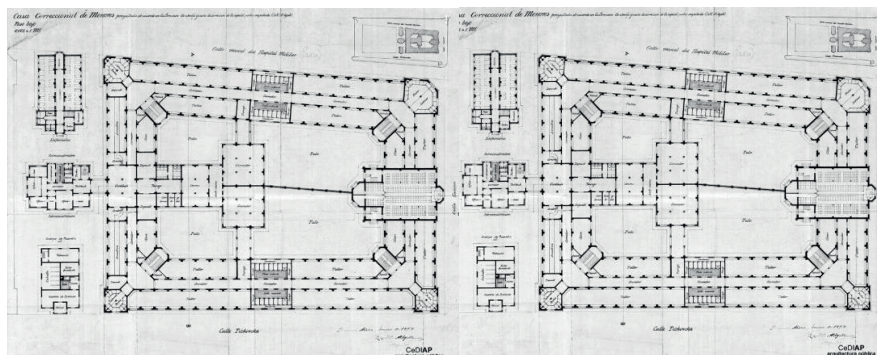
a la izquierda planta baja, a la derecha planta alta de la Casa Correccional de Menores. Carlos y Hans Altgelt 1894
